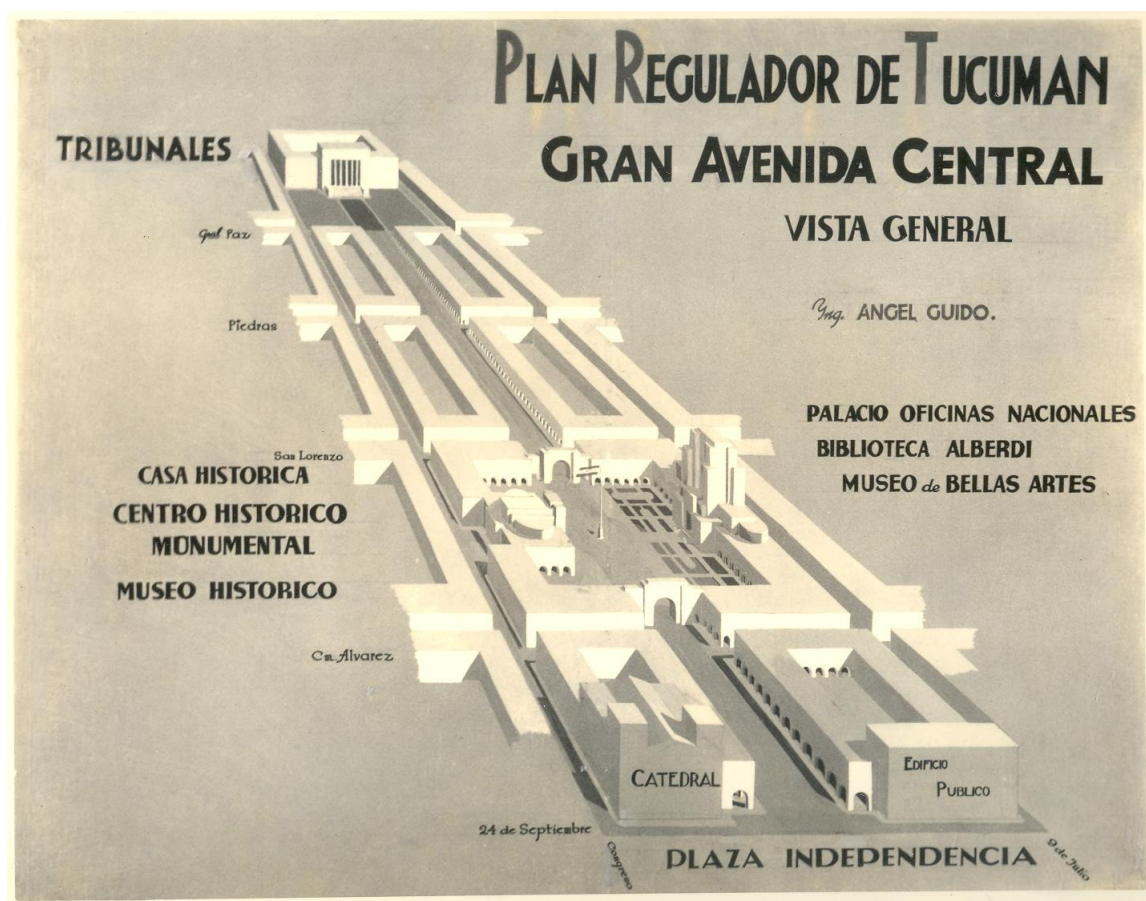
Primera propuesta para el Plan Regulador. Guido, 1937
